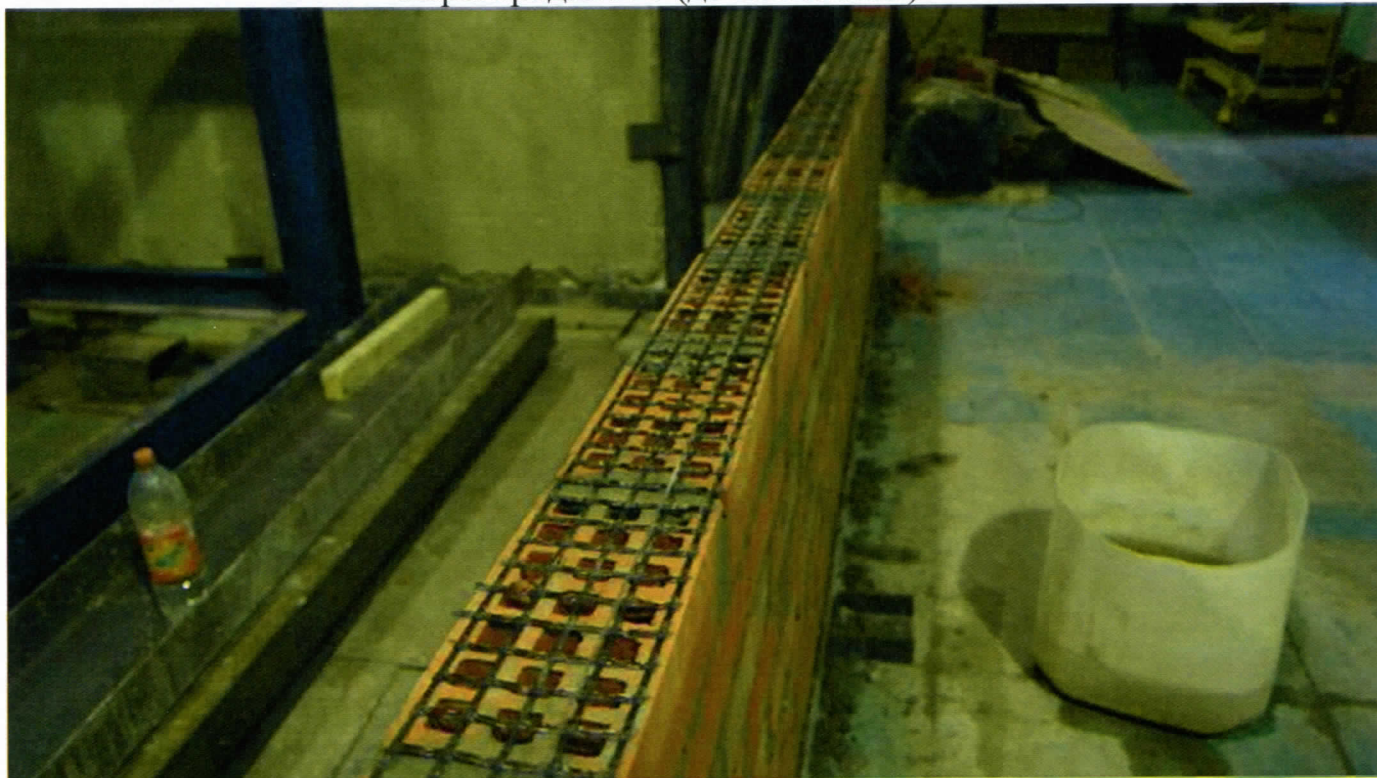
Раскладка горизонтальной арматуры
